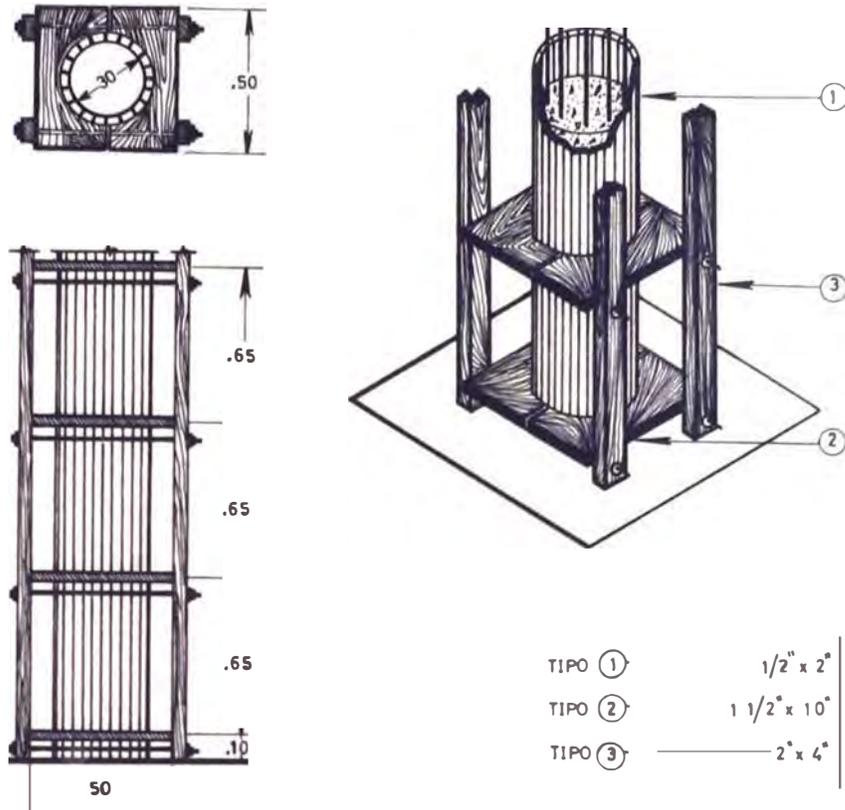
ENCOFRADO DE COLUMNA CIRCULAR - D=.30m
